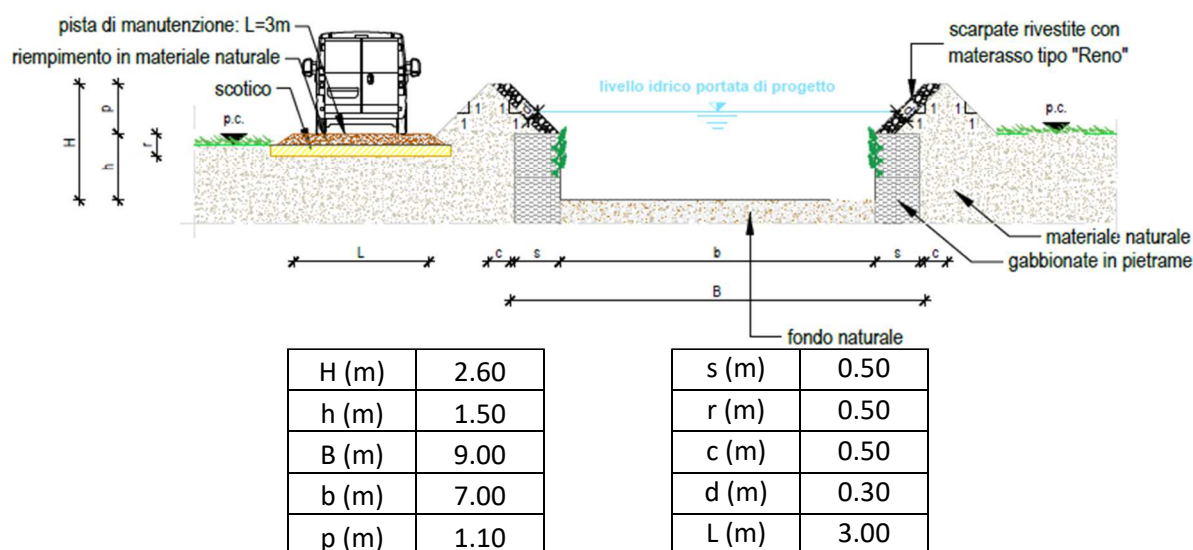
Sezione tipologica di progetto del tratto CIR-01-02.
